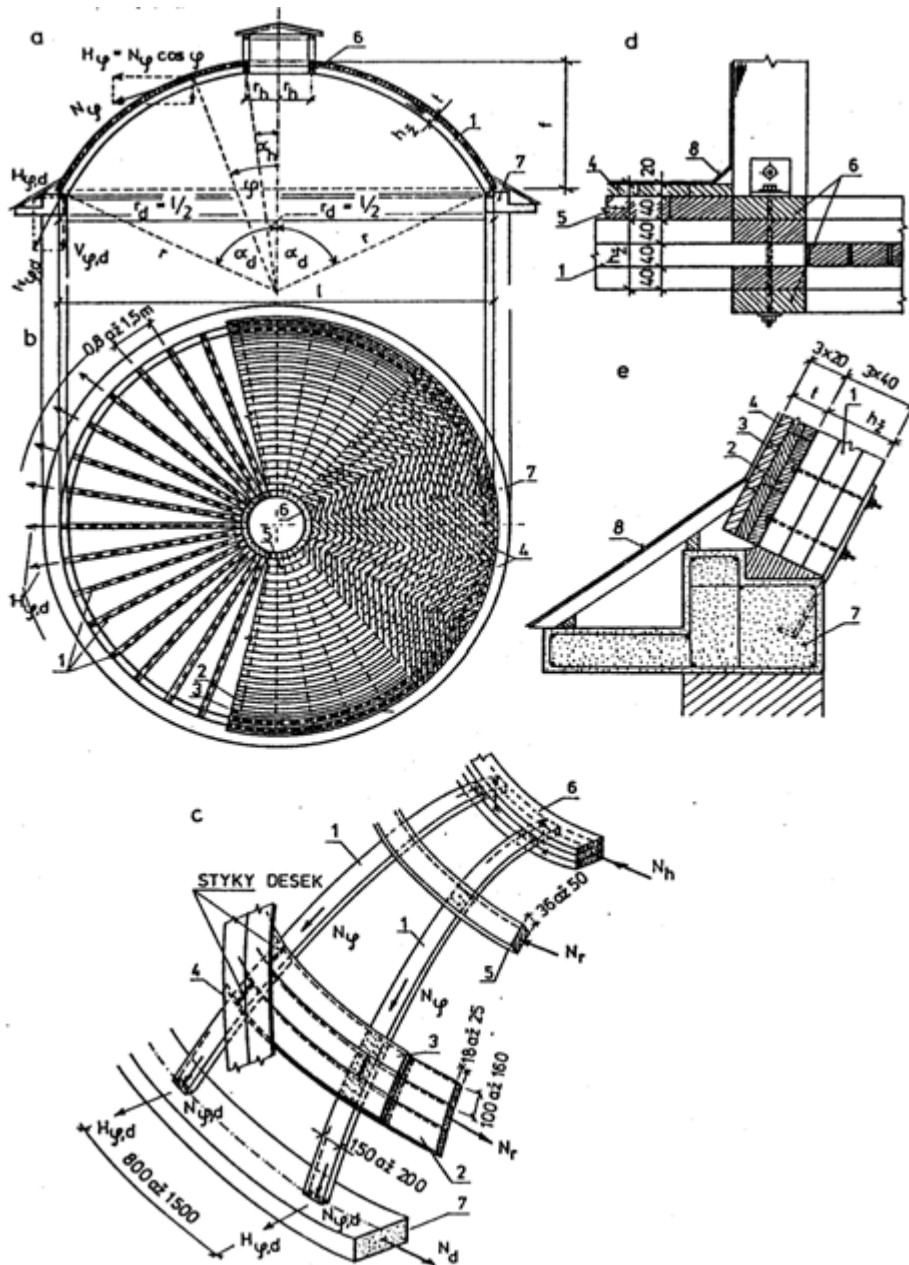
K působení dřevěných krátkých skořepin:
